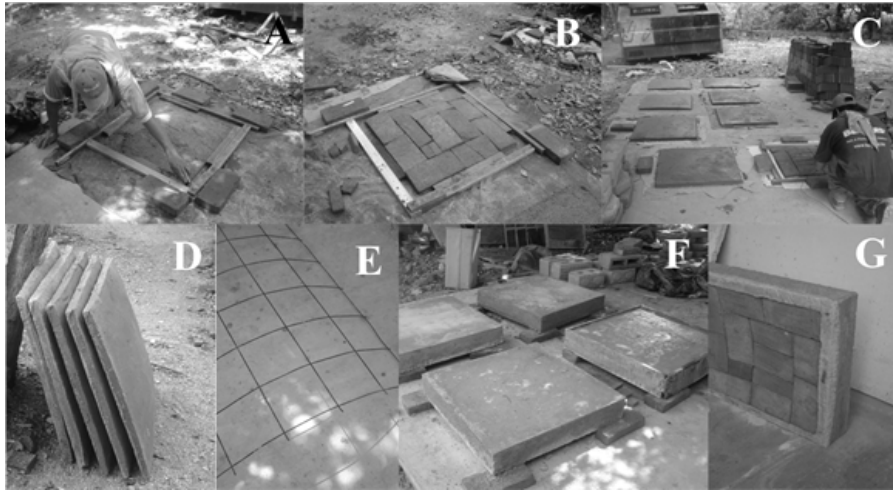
Construcción de elemento Domotej para ensayar. En la foto A, colocación de arena; en foto B, posicionamiento de ladrillos; en la foto C, Colocación del mortero; en la foto D, Componentes acabados; en la foto E y F, Colocación de armado de acero y capa de compresión; en la foto G, componente con capa de compresión colocada, listo para la prueba.
